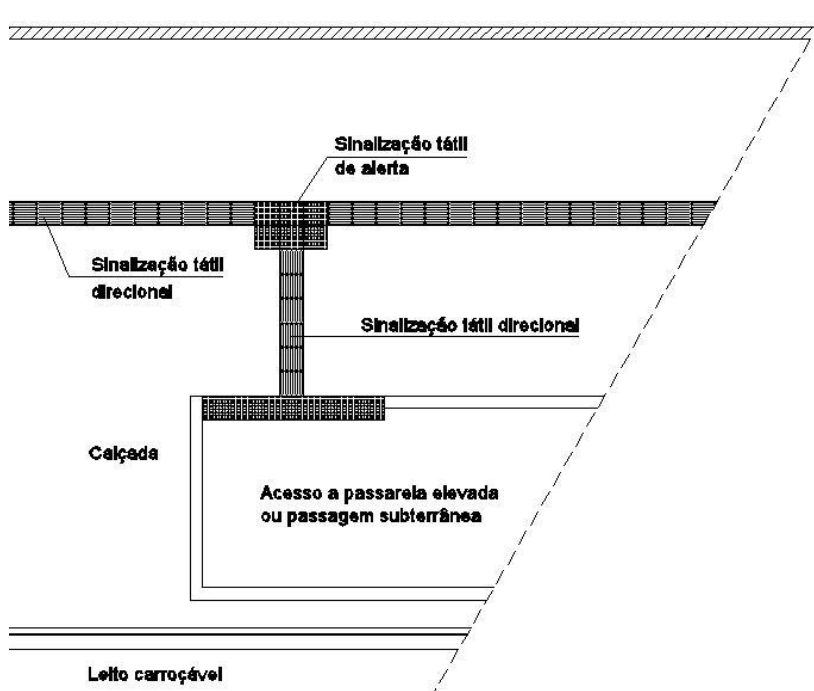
Passarelas elevadas e travessias subterrâneas em calçada com sinalização tátil direcional
